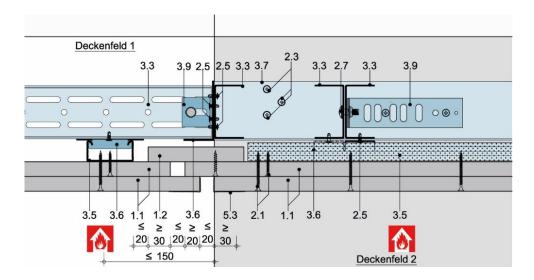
Flurkreuzung einer zweilagig beplankten Weitspannträgerdecke mit Schattenfuge
